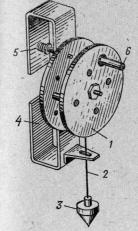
1— барабан; 2 — шнур причальный; 3 — отвес: 4 ручка-скоба: 5 — фиксатор:
